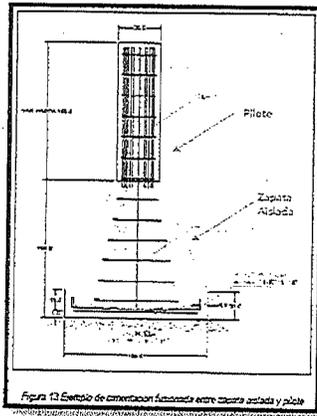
Corte de cimentación combinada entre zapata aislada y pilote
